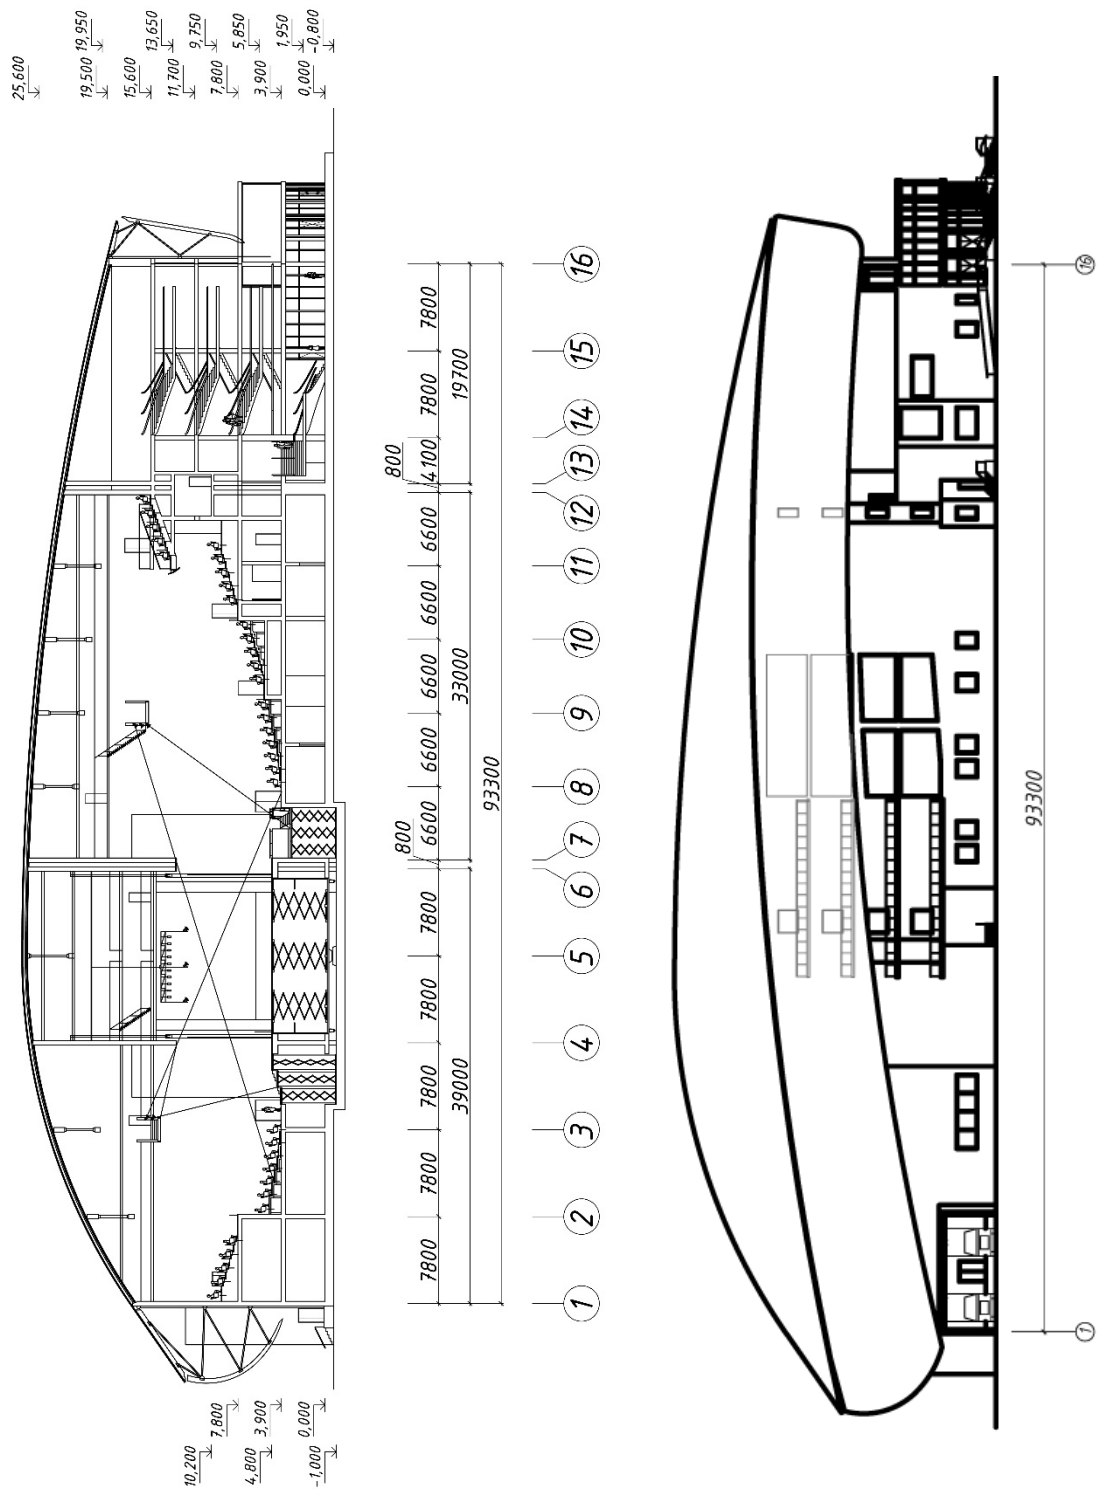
Схема: а – повздовжній переріз; б – фасад по вулиці Крутогірний узвіз.
